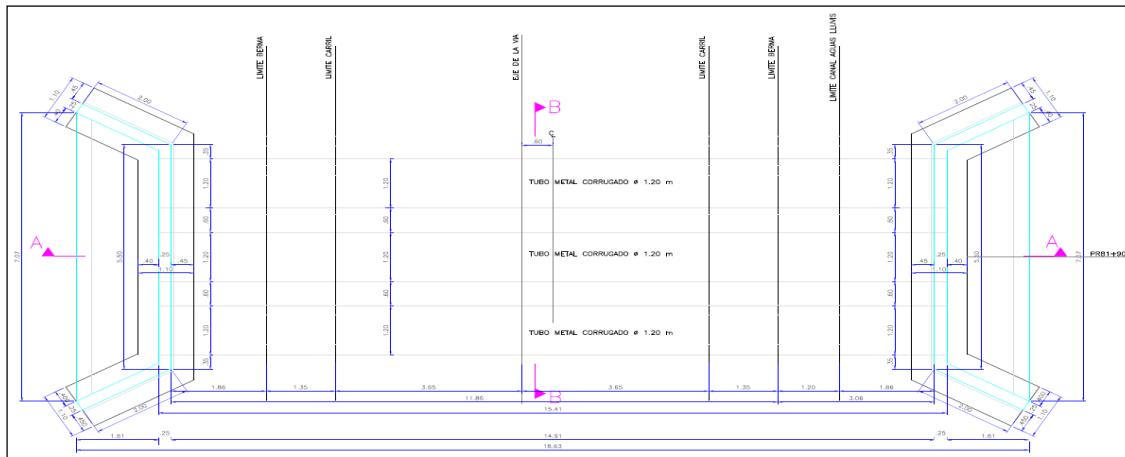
Planos de diseño tubería metálica corrugada para la obra de drenaje PR81+190
